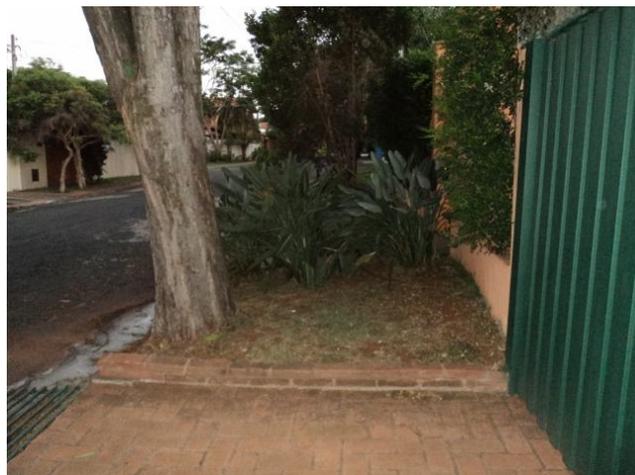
Degrau e plantas impróprios em casa da Rua Shigeo Mori.
